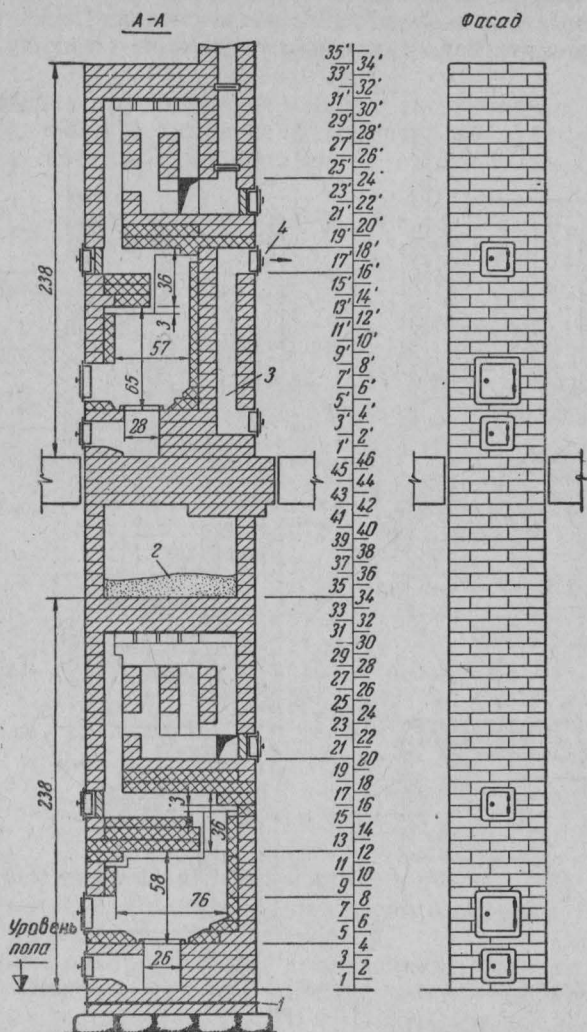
Конструкция и основные размеры одного из типов двухъярусной печи:
